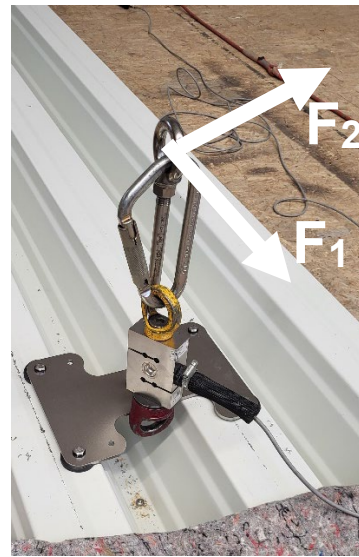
Prüfaufbau 6, Anschlagereinrichtung,
